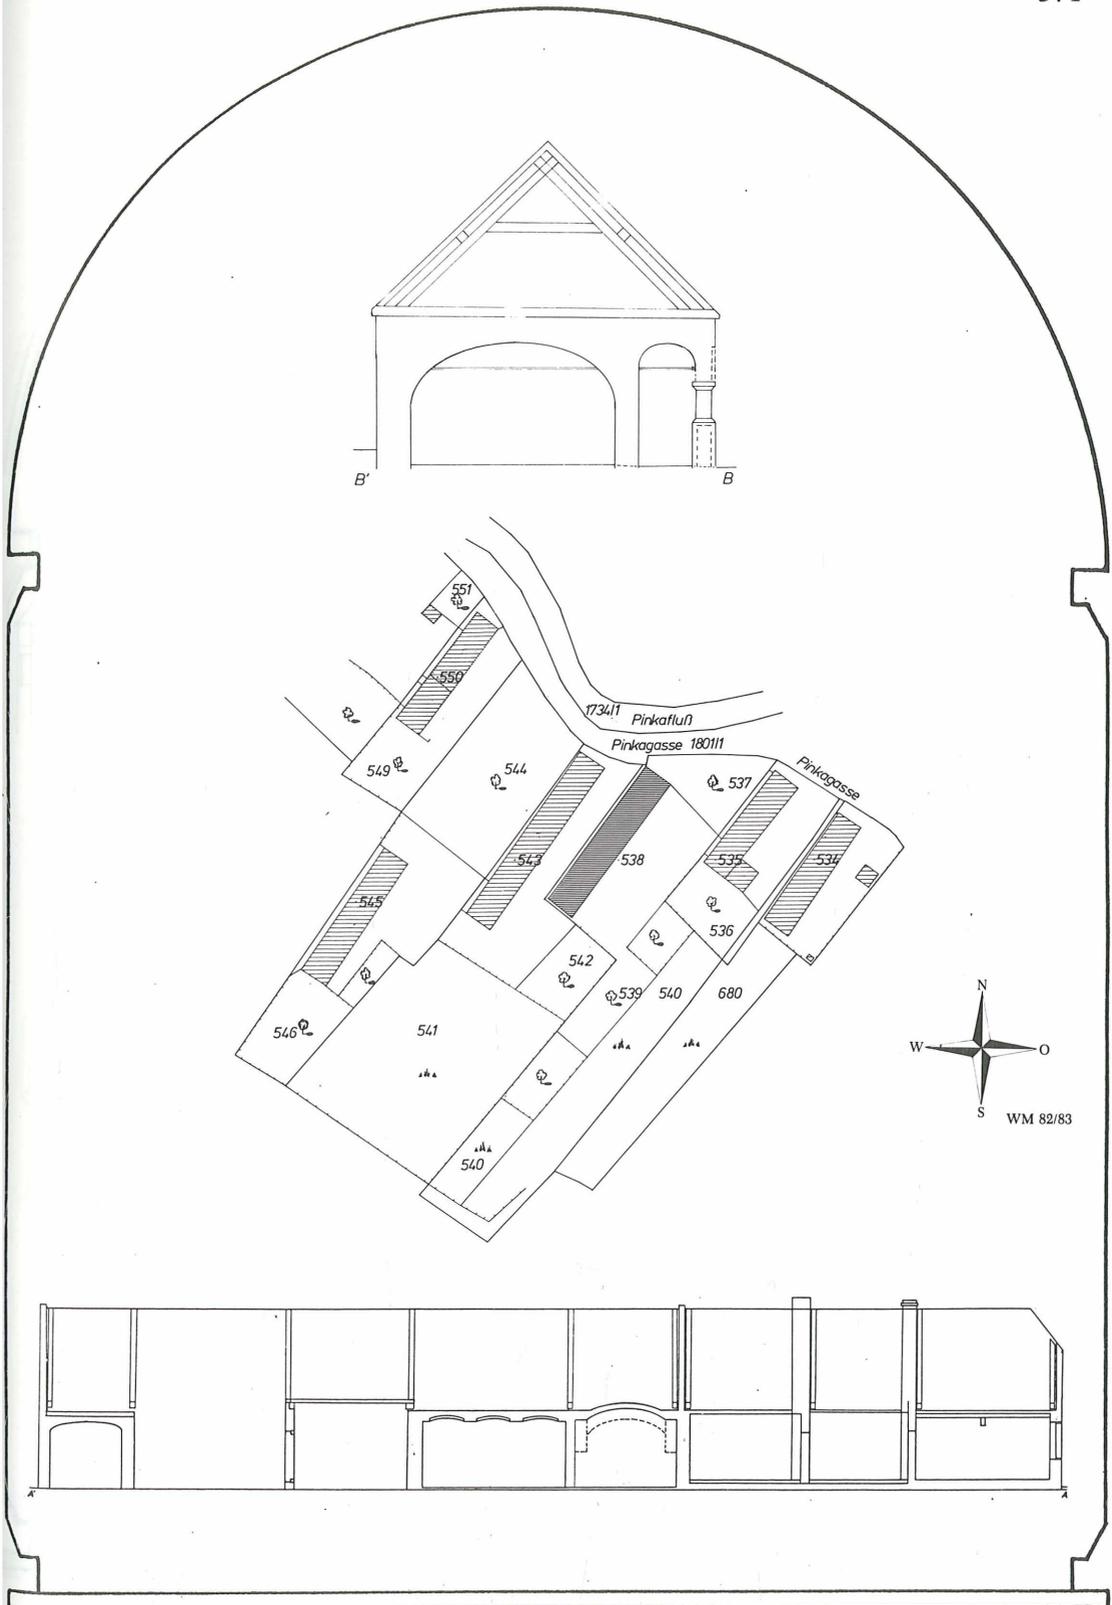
Oberwart, Pinkagasse 22 - Schnitte, Details und Lageplan
